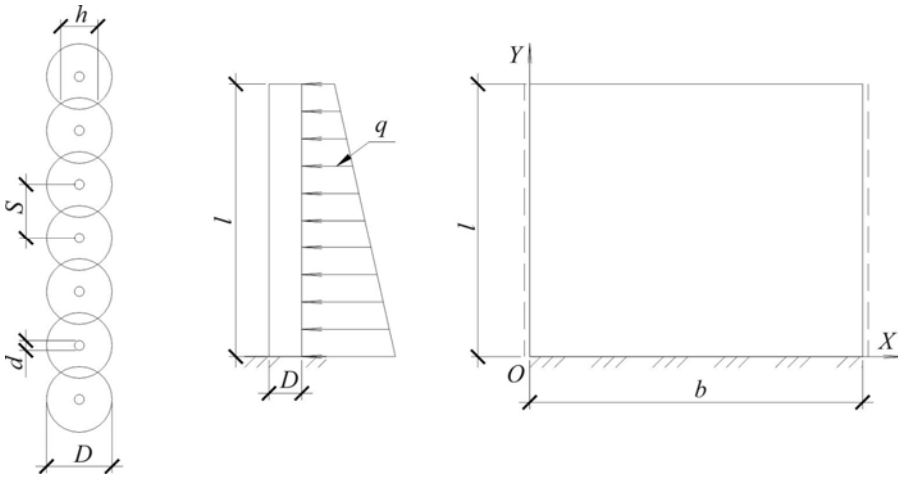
Схема ограждающей конструкции котлована, выполненной из армированных грунтоцементных элементов
